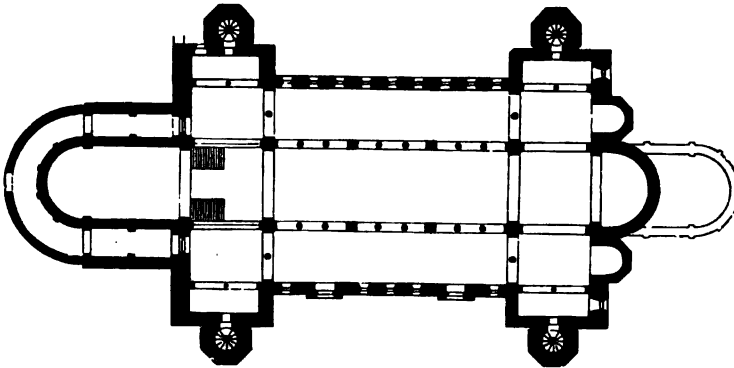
Grundriss einer doppelchörigen romanischen Basilika
